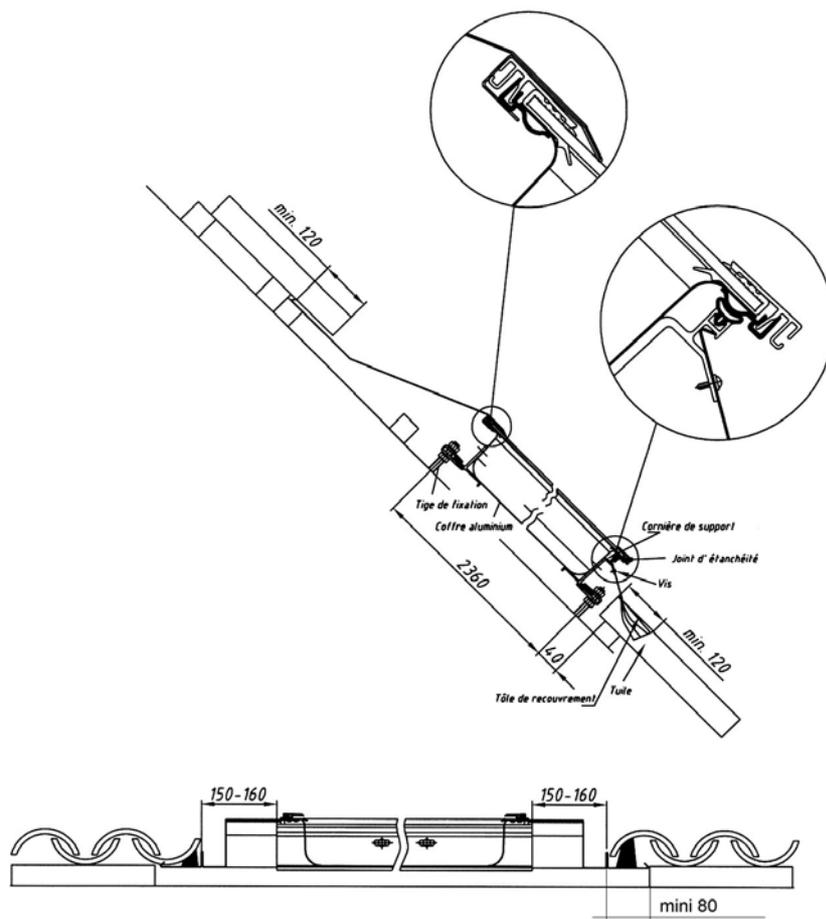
Implantation dans une toiture en tuile canal – vue en coupe
